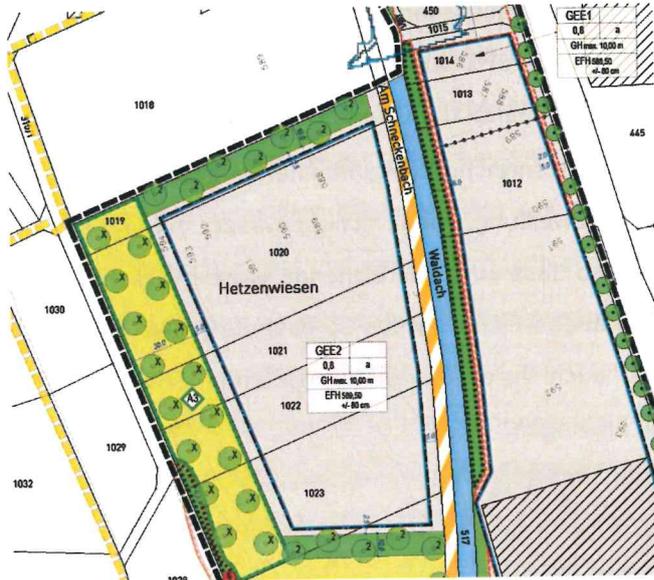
Ausschnitt aus dem nordwestlichen Teil des Bebauungsplan-Entwurfs mit verbliebener Entwicklungsfläche als GEE
